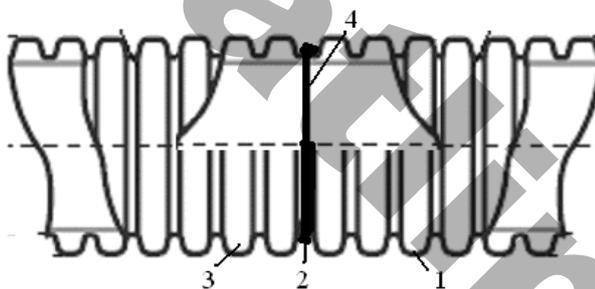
Сварное соединение ПТ2См (ПТ2Сг) между собой, выполненное НИ:
